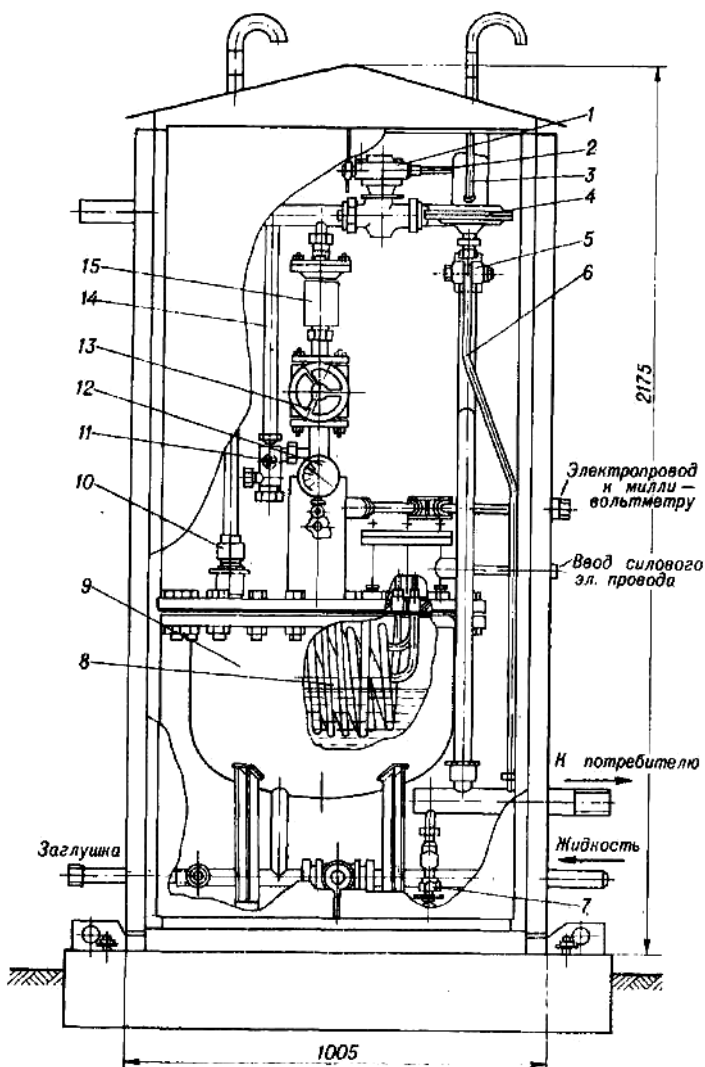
Схема резервуарной установки с испарителями ИМЭ-10М:
